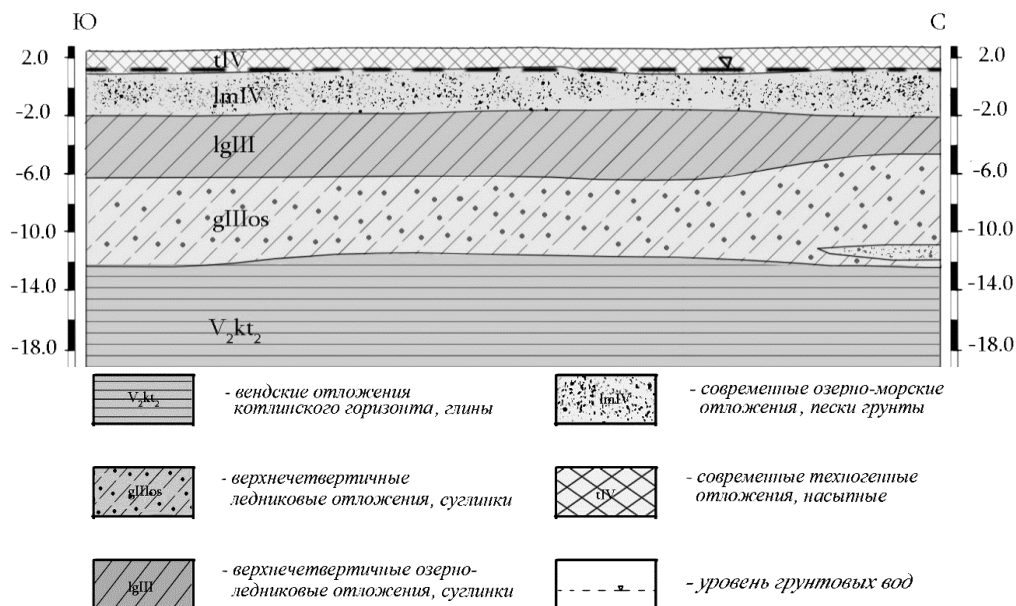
Схематический геолого-гидрогеологический разрез строительной площадки
